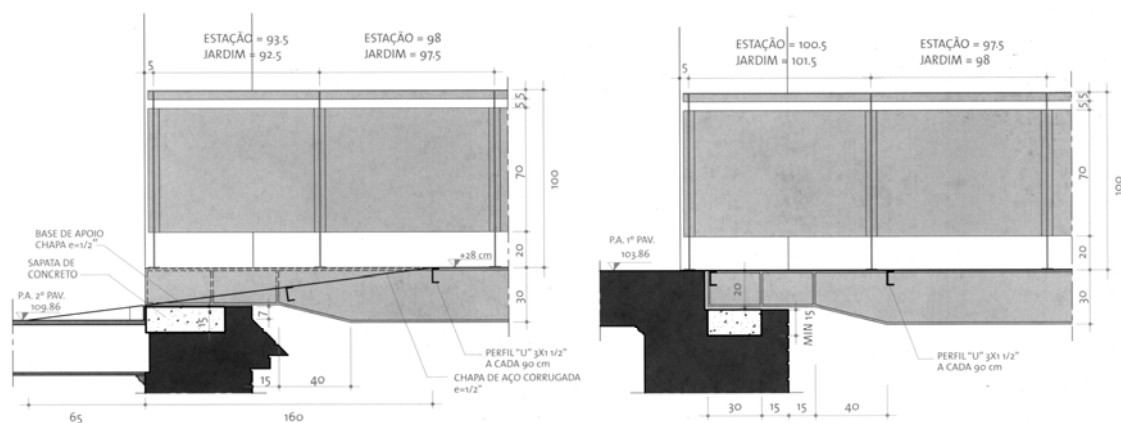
Detalhes das passarelas do segundo e primeiro pavimentos.
